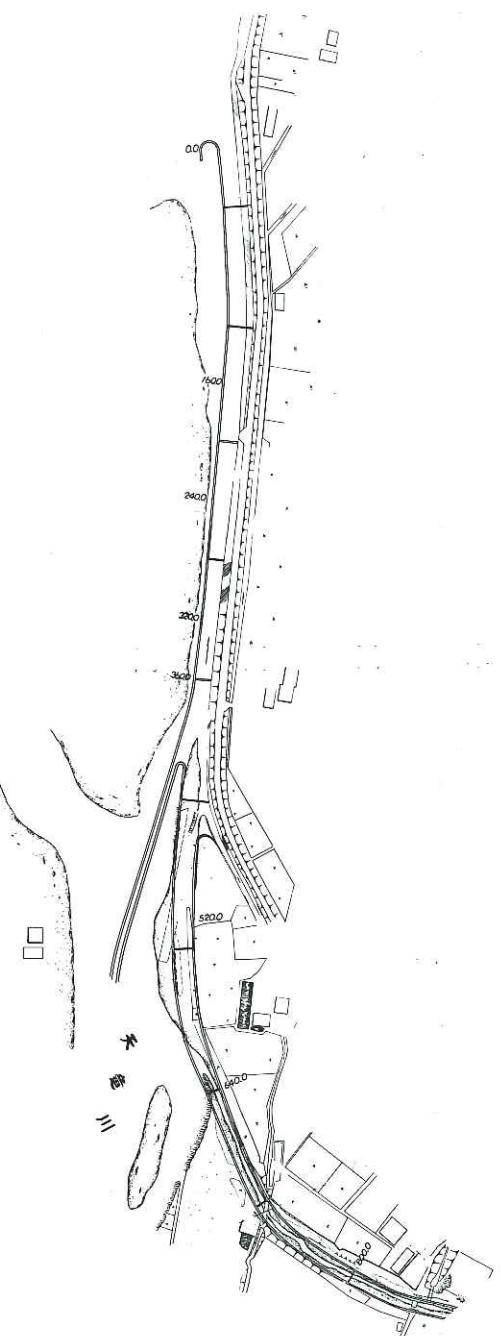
南大島川平面図 縮尺1/5,000(1)(2)
